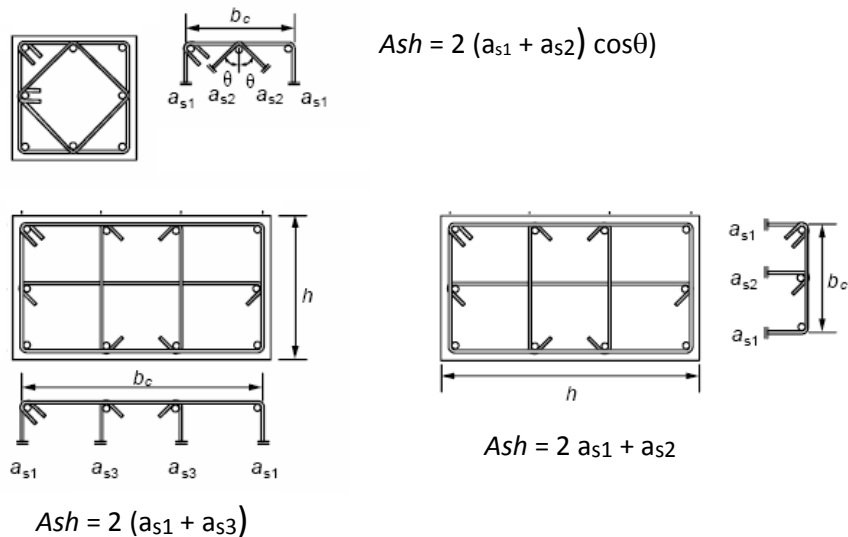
Ejemplos de determinación de Ash
